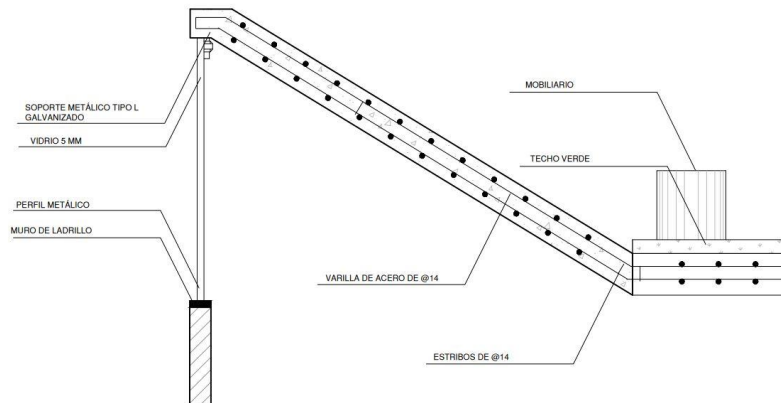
Detalle de claraboyas – anclaje de vidrio a pared
